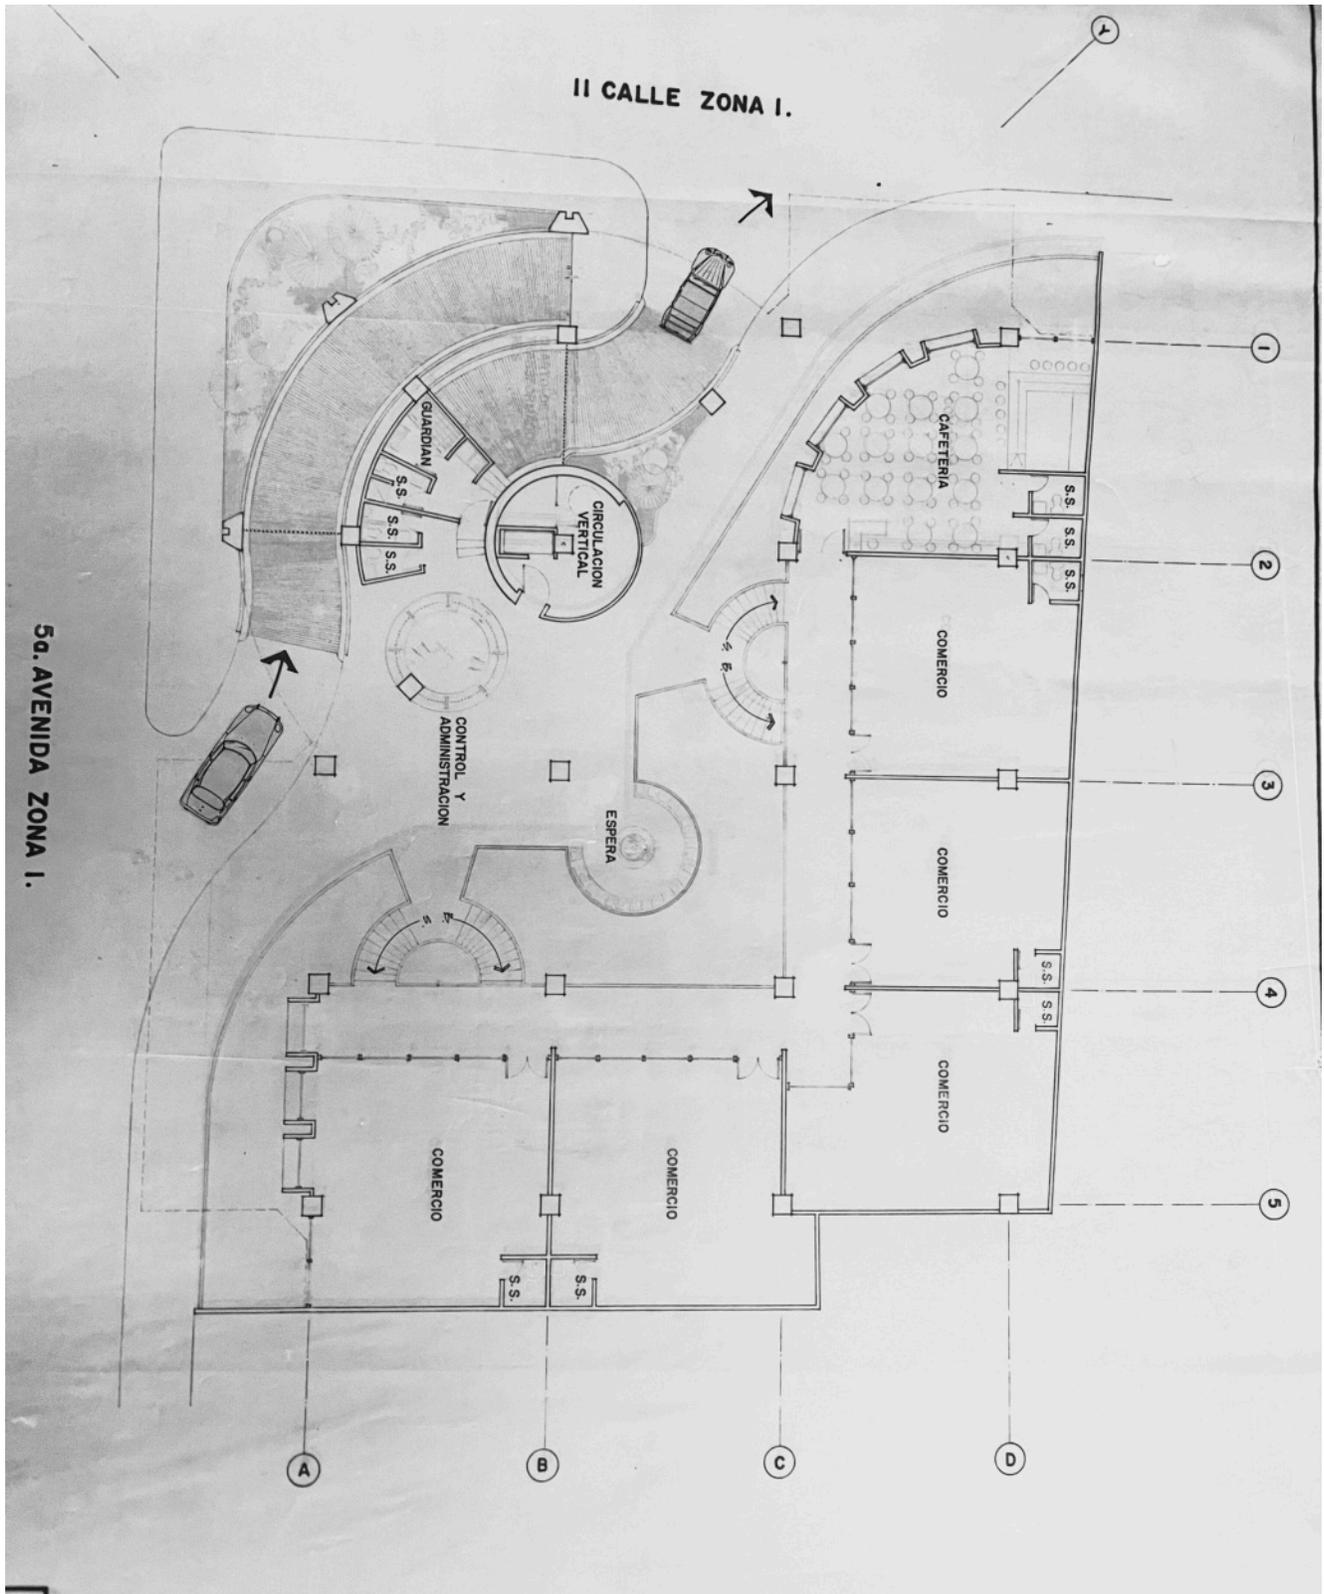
| Planta baja; 1/35, Torre de Estacionamiento.
